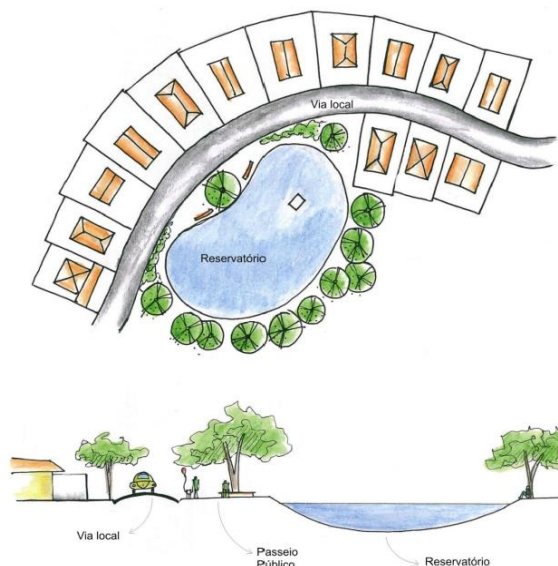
Implantação de estrutura de armazenamento em área urbana.
